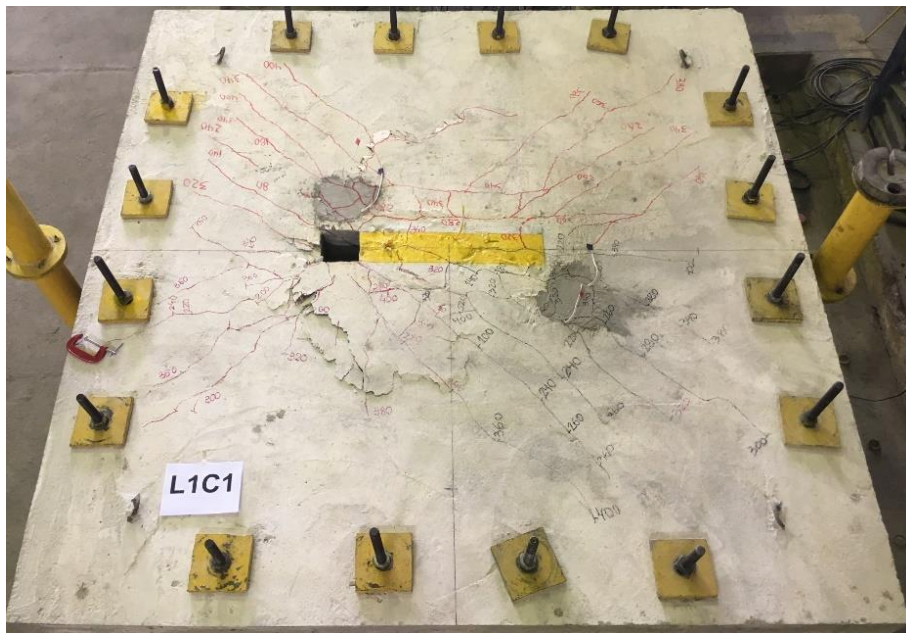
Padrão de fissuração da laje L1C1
